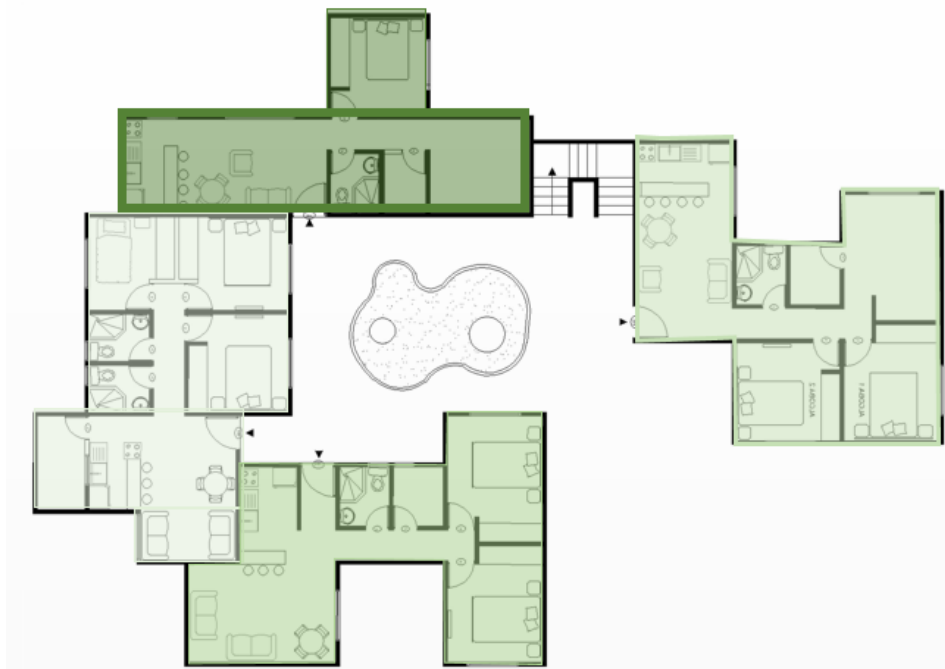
Planta arquitectónica del primer piso en la Torre Toribío, con cuatro apartamentos
